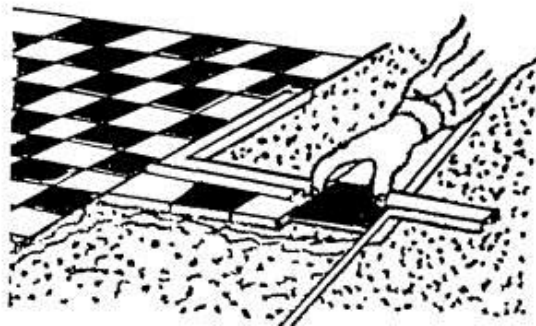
Укладка полосок из одного ряда плиток по угольнику
